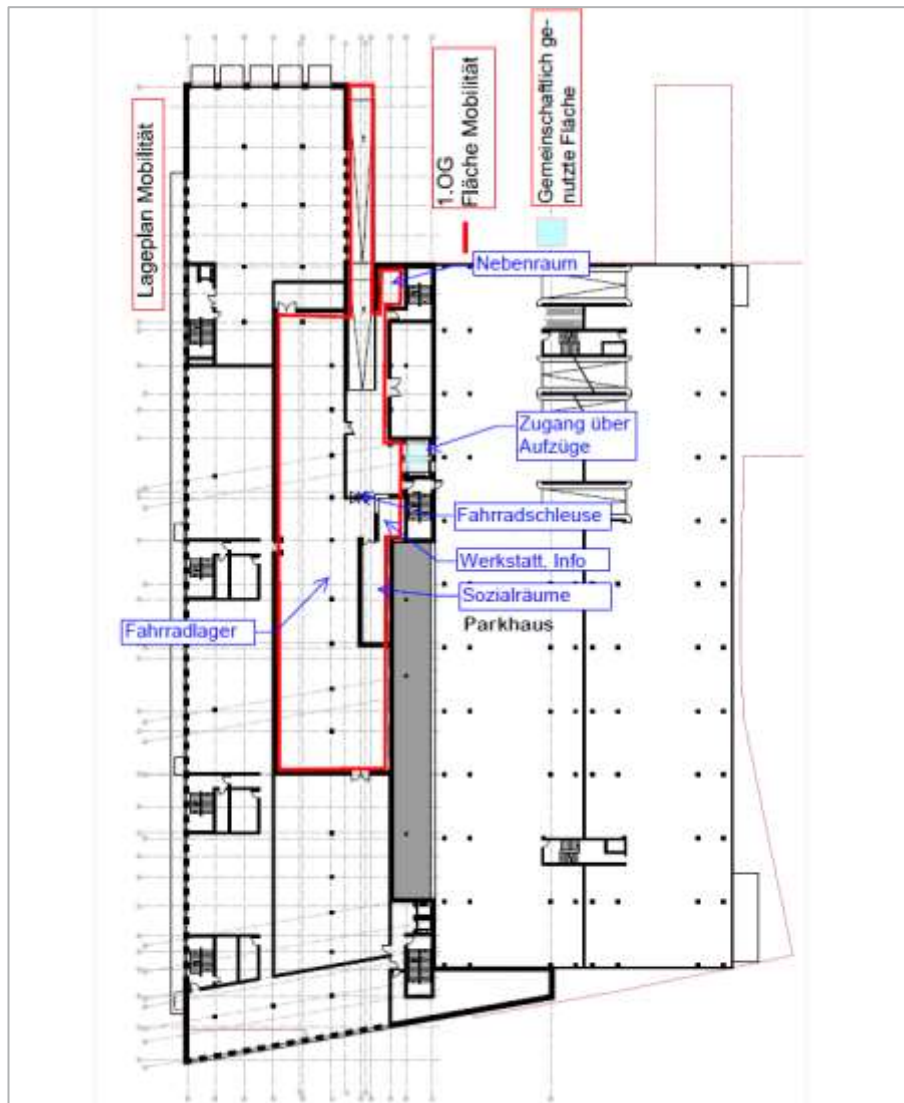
Grundriss mit Radstation im 1. OG (rot umgrenzter Bereich)
